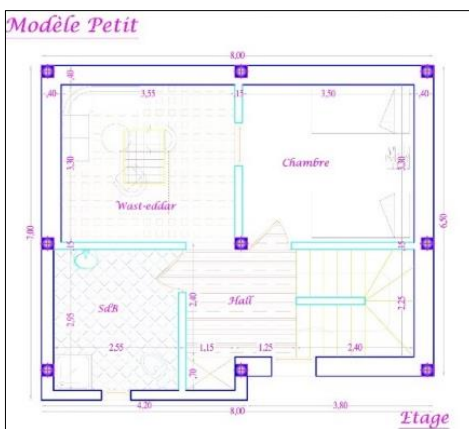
plan de l'étage type petit. source : fondation amidoul
